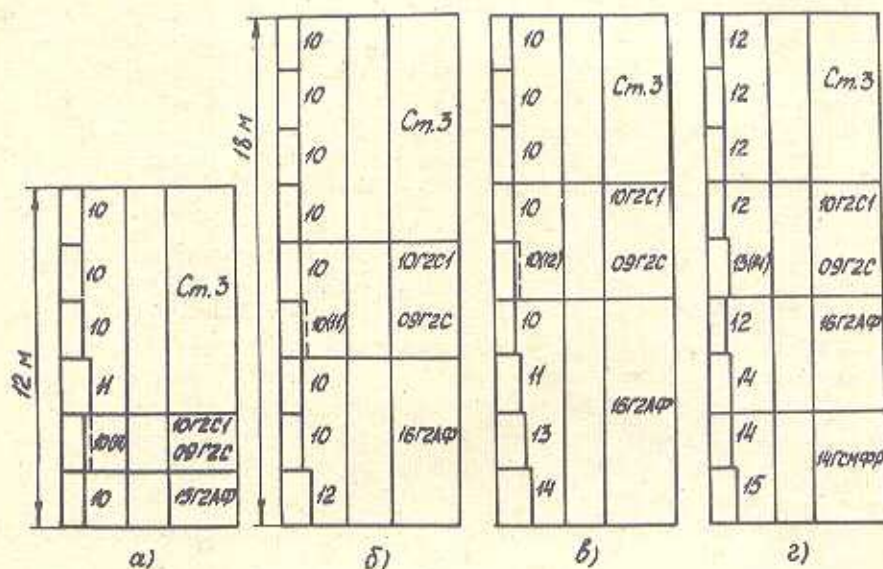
Рекомендуемые толщины стенок резервуаров
